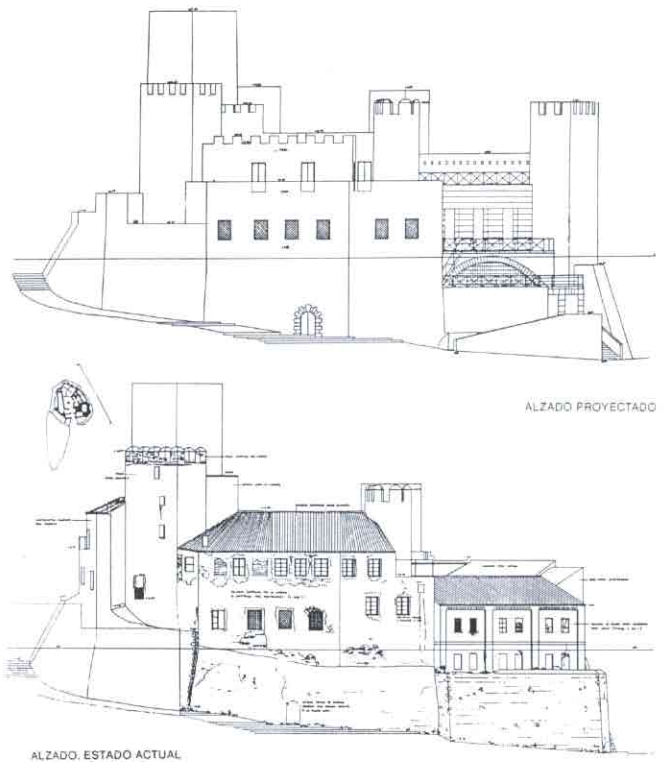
Alzados anterior y posterior a la intervención, donde se observa la zona de habitaciones construida por los marqueses.
